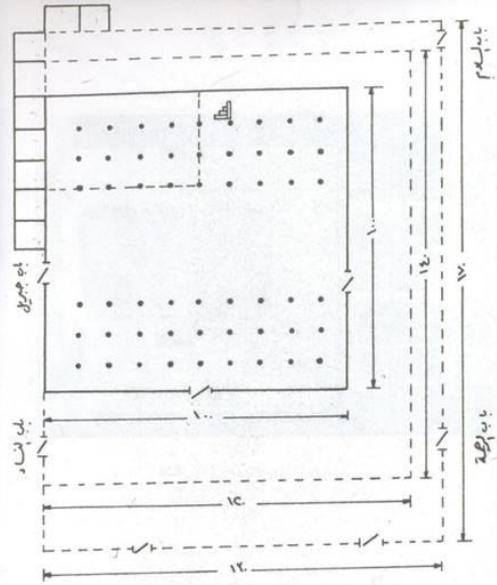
مسقط أفقي لمسجد قصر الوليد (قصر المنية) . (عن كونل).
